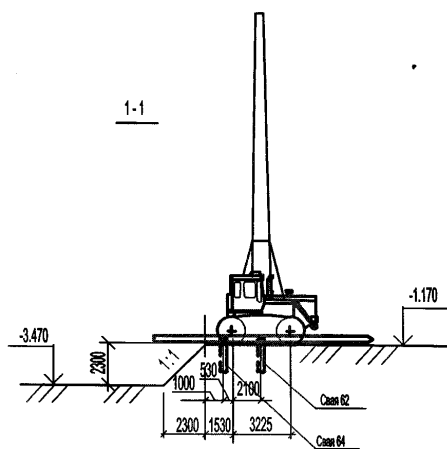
Вертикальная схема расчетного участка с пригрузом по верхнему краю откоса от веса сваебойного копра СП-49 и сваи С12-35 (расположение копра и сваи перпендикулярно бровке котлована для забивки 62-ой сваи) (вариант 5)
